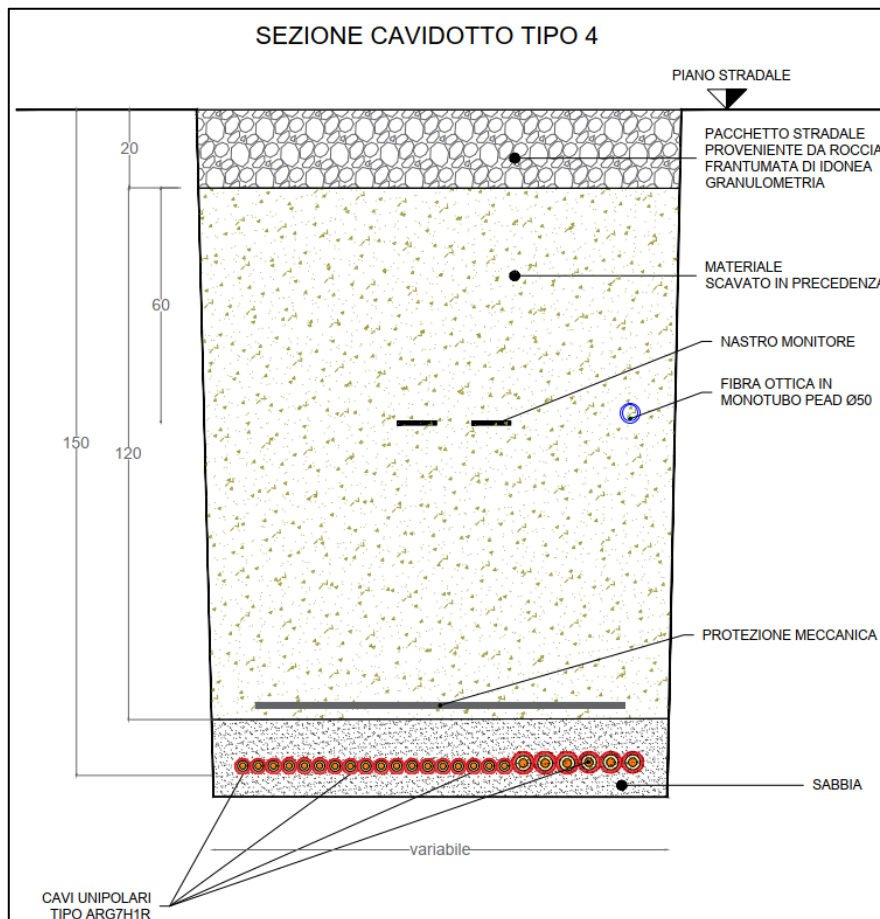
Sezione di posa cavidotto MT a 30 kV – tipo 4
